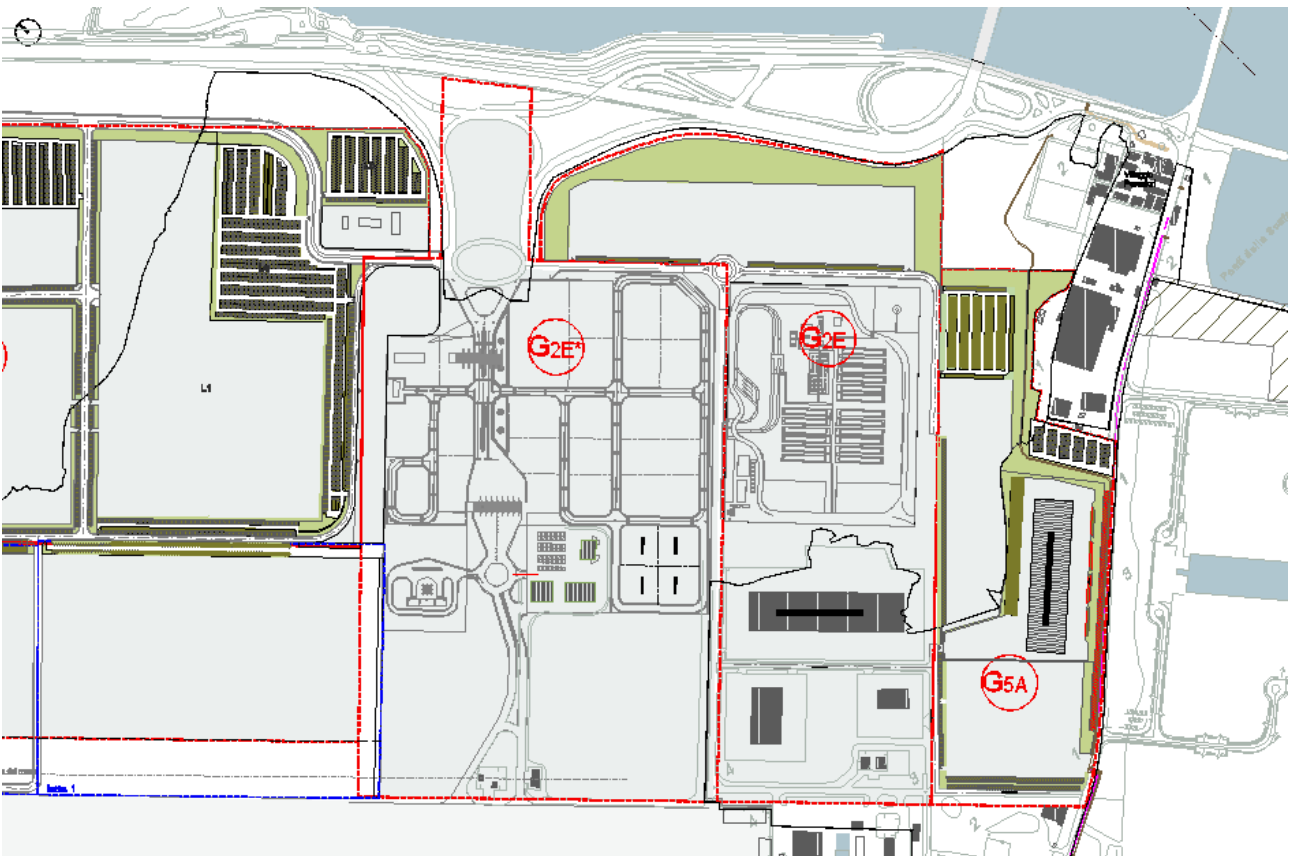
stralcio planimetrico sottozone G2E - G2E – G5A (tavola A8 del Piano Attuativo)
